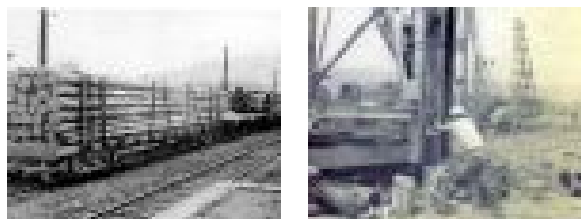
鉄道で出荷される杭丸太と基礎杭打設の状況
